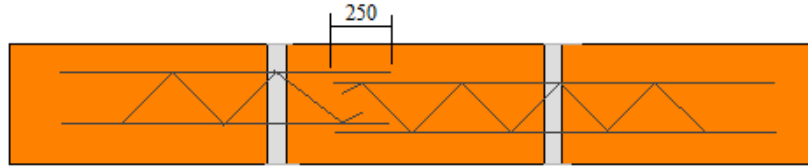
Detalhe em planta do trespassamento da armadura – medida em milímetros (adaptada do Manual técnico de utilização de Murfor em alvenaria (Nascimento, 2007).
